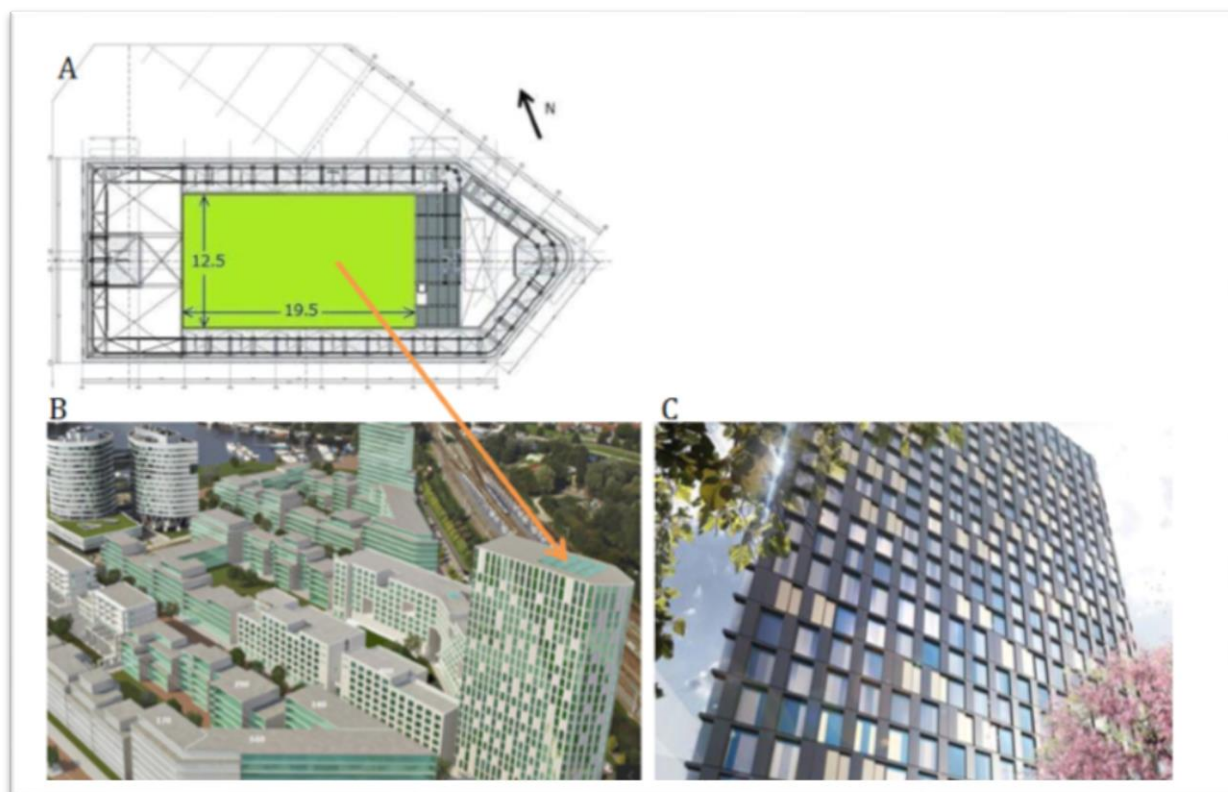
A : Plan de l'hôtel Amstelkwartier situé sur le toit, B : Environnement de l'hôtel Amstelkwartier et C : Façade sud de l'hôtel Amstelkwartier.
